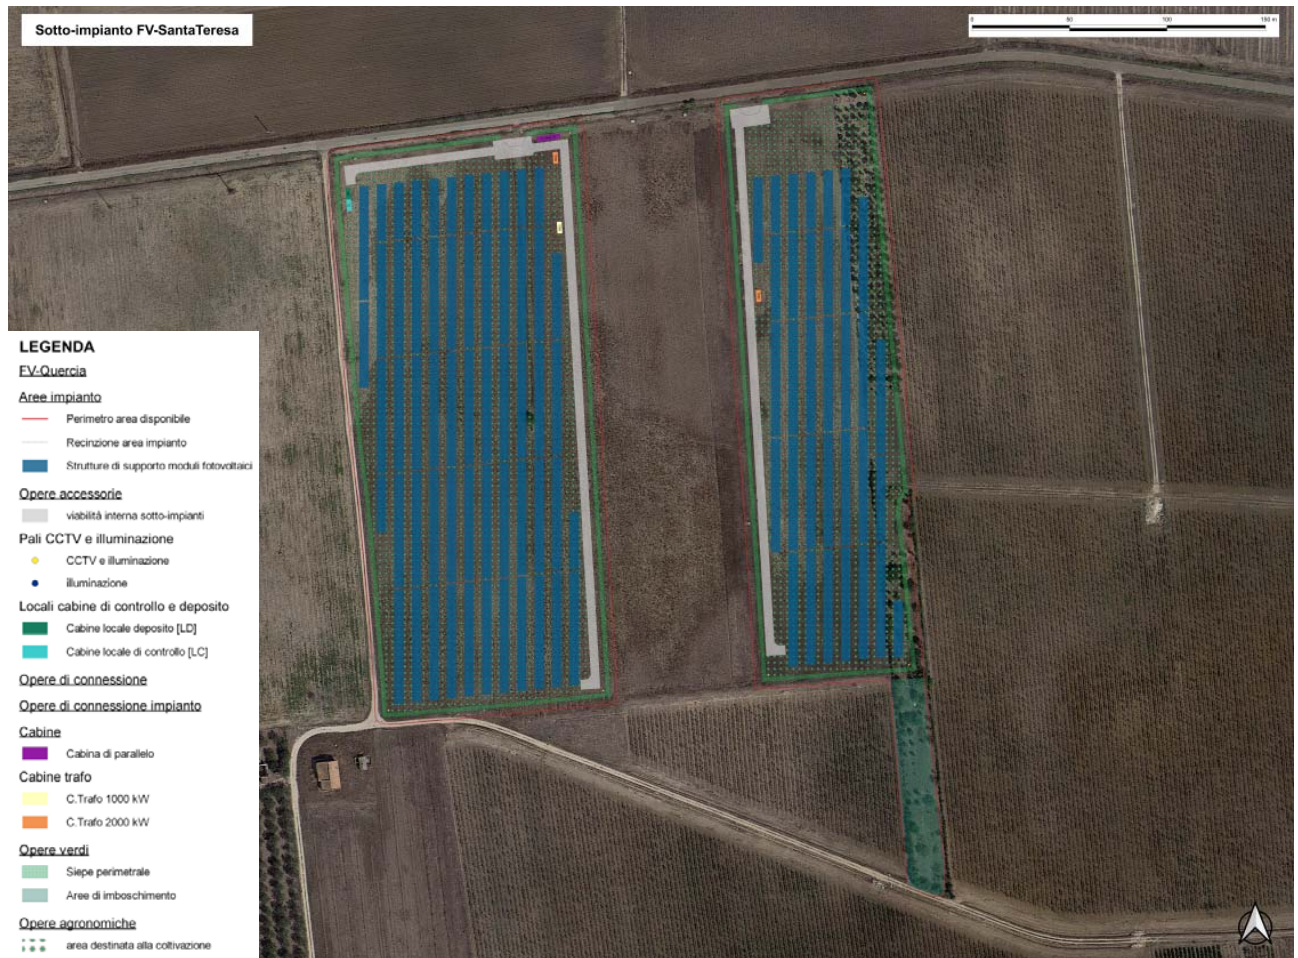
Layout agro-fotovoltaico sotto-impianto FV-Santa Teresa
